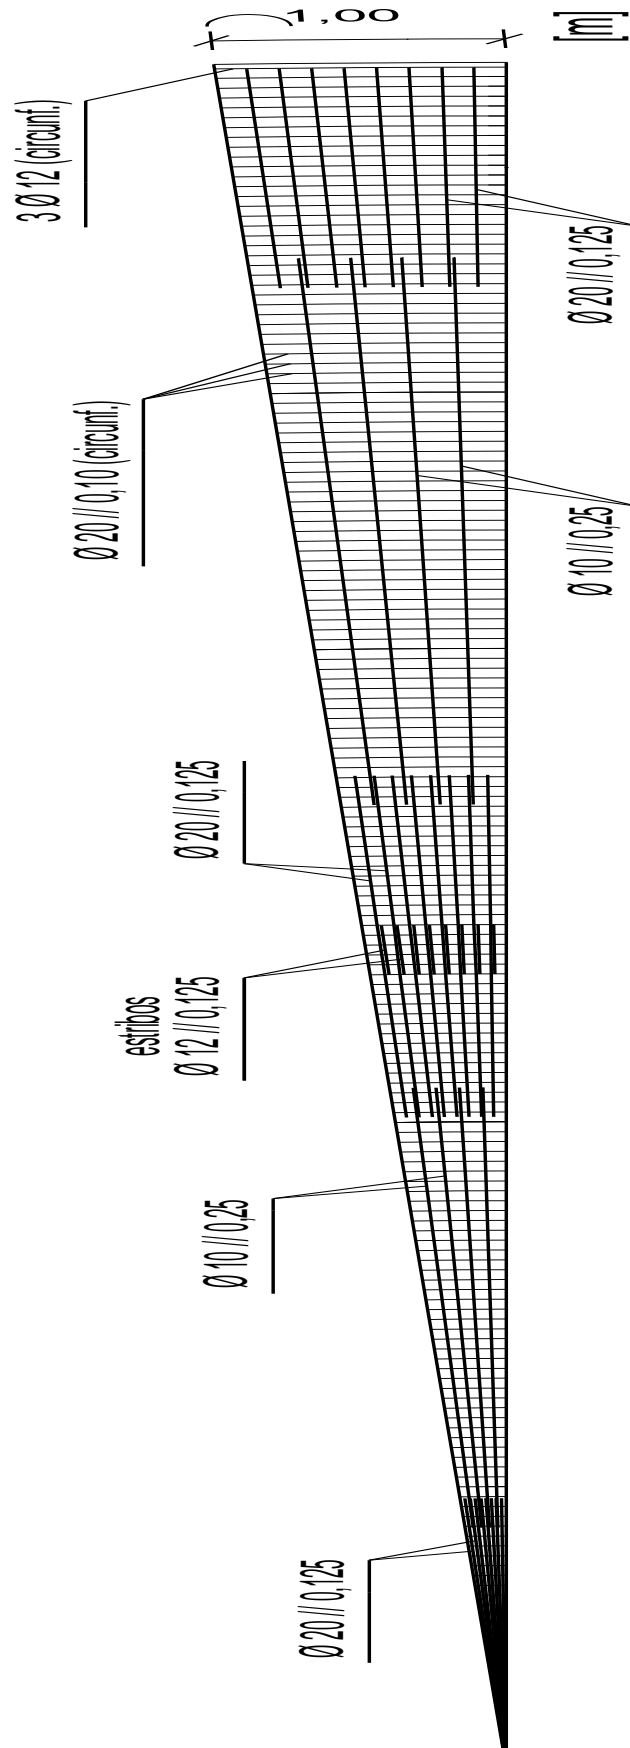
Armadura superior da laje de fundo (representação por metro de faixa de laje).
